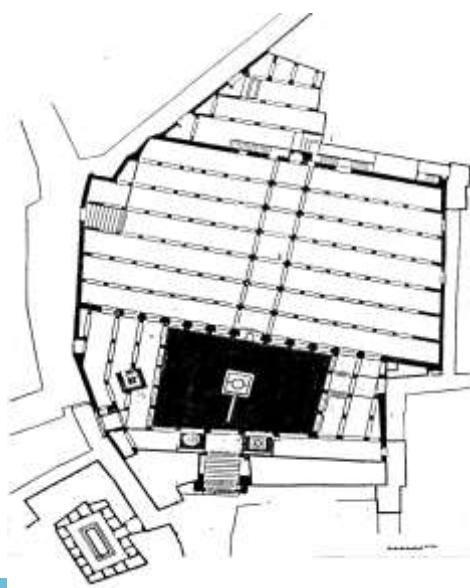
مسقط أفقى لجامع باب دكالة بمراكش
